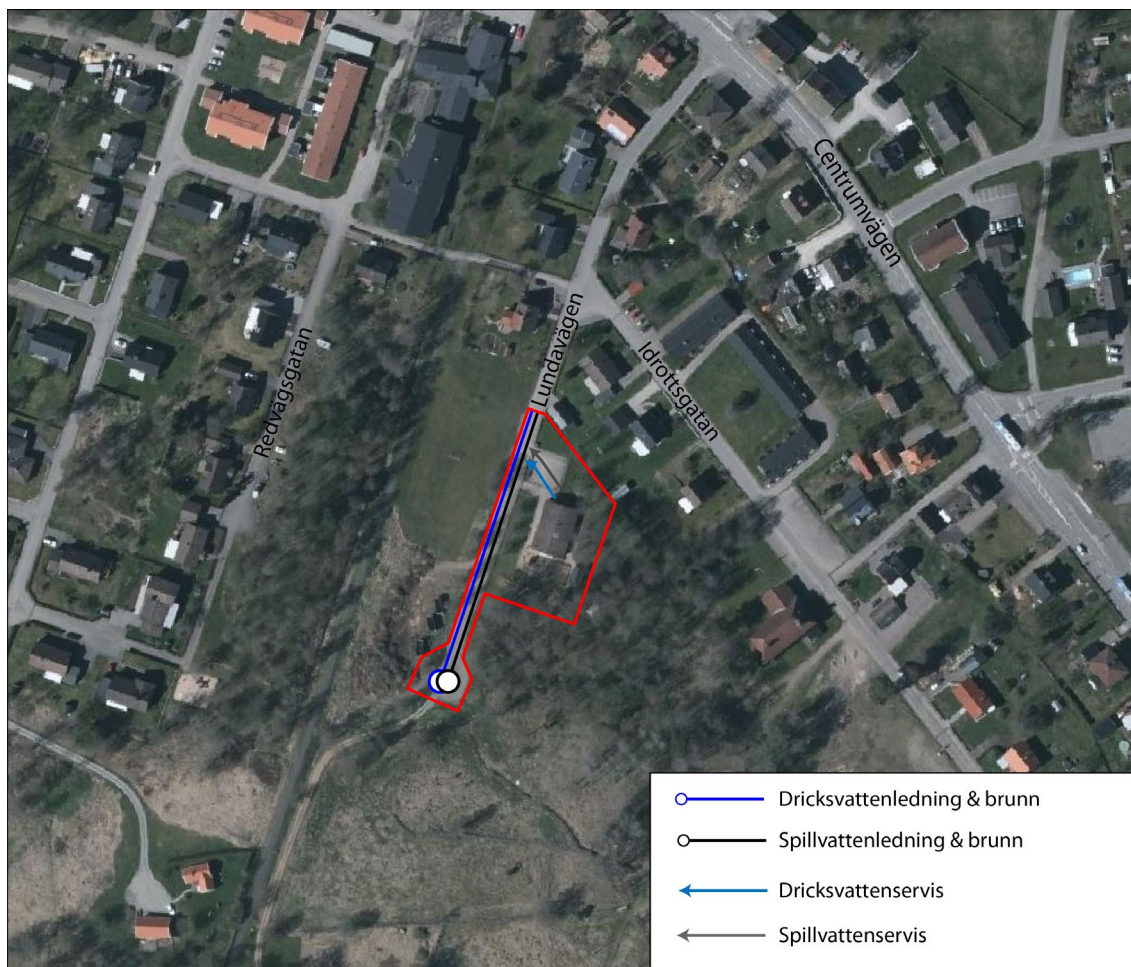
visar dricks- och spillvattenledningar inom planområdet och befintliga serviser till dessa ledningar.
